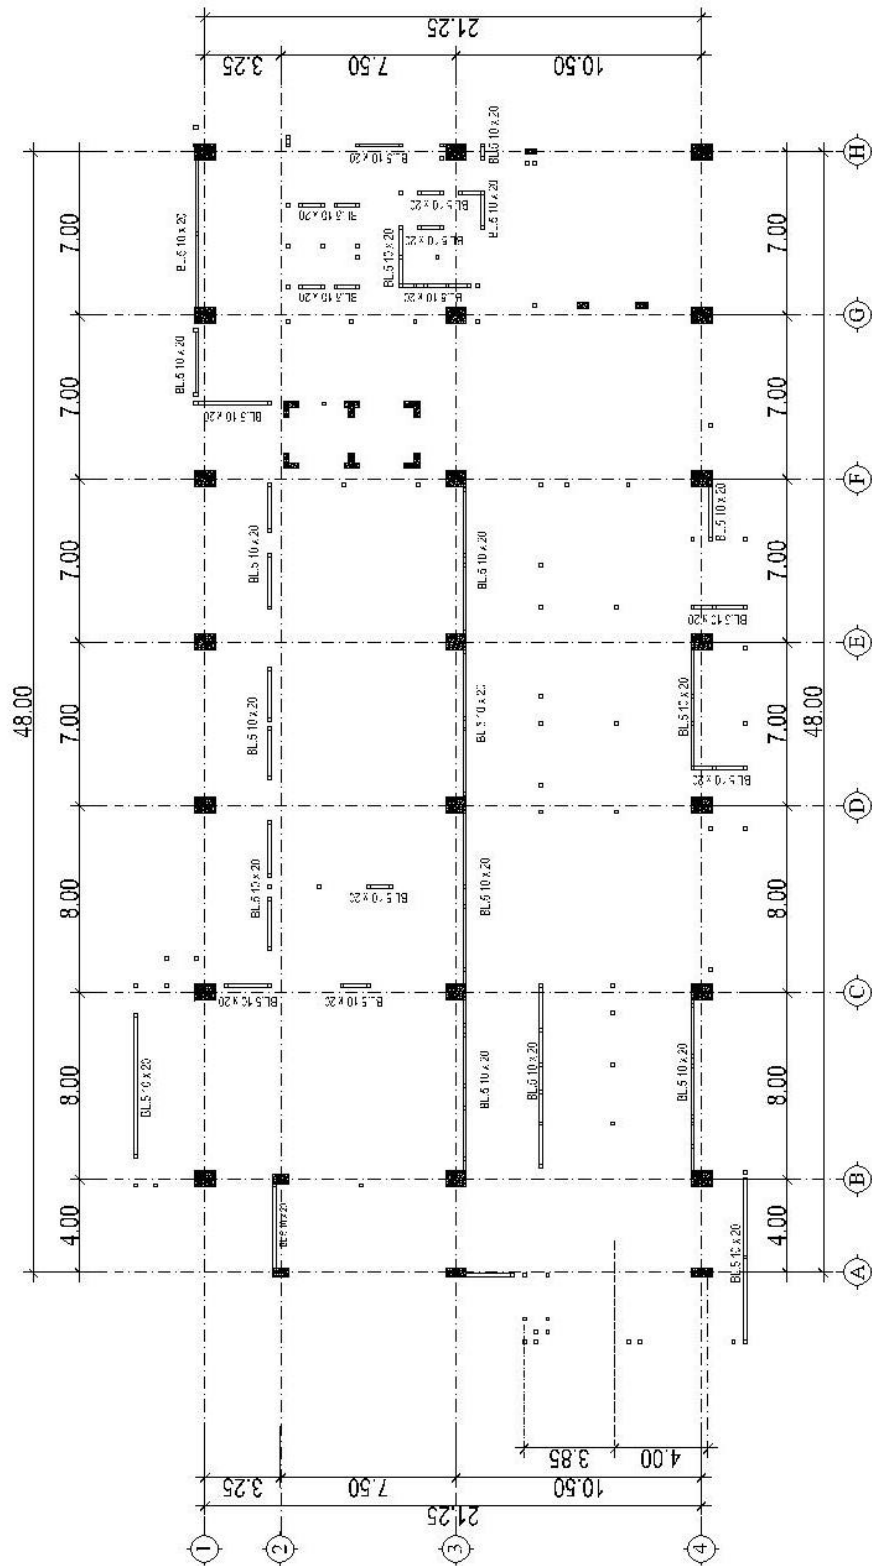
Denah Rencana Balok Elv. + 14.04
